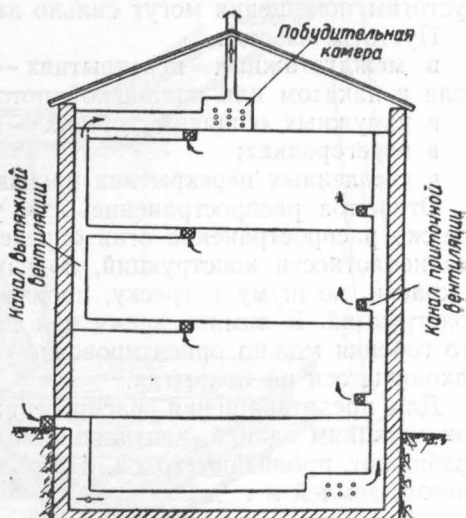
Схема приточно-вытяжной вентиляционной системы дома.
